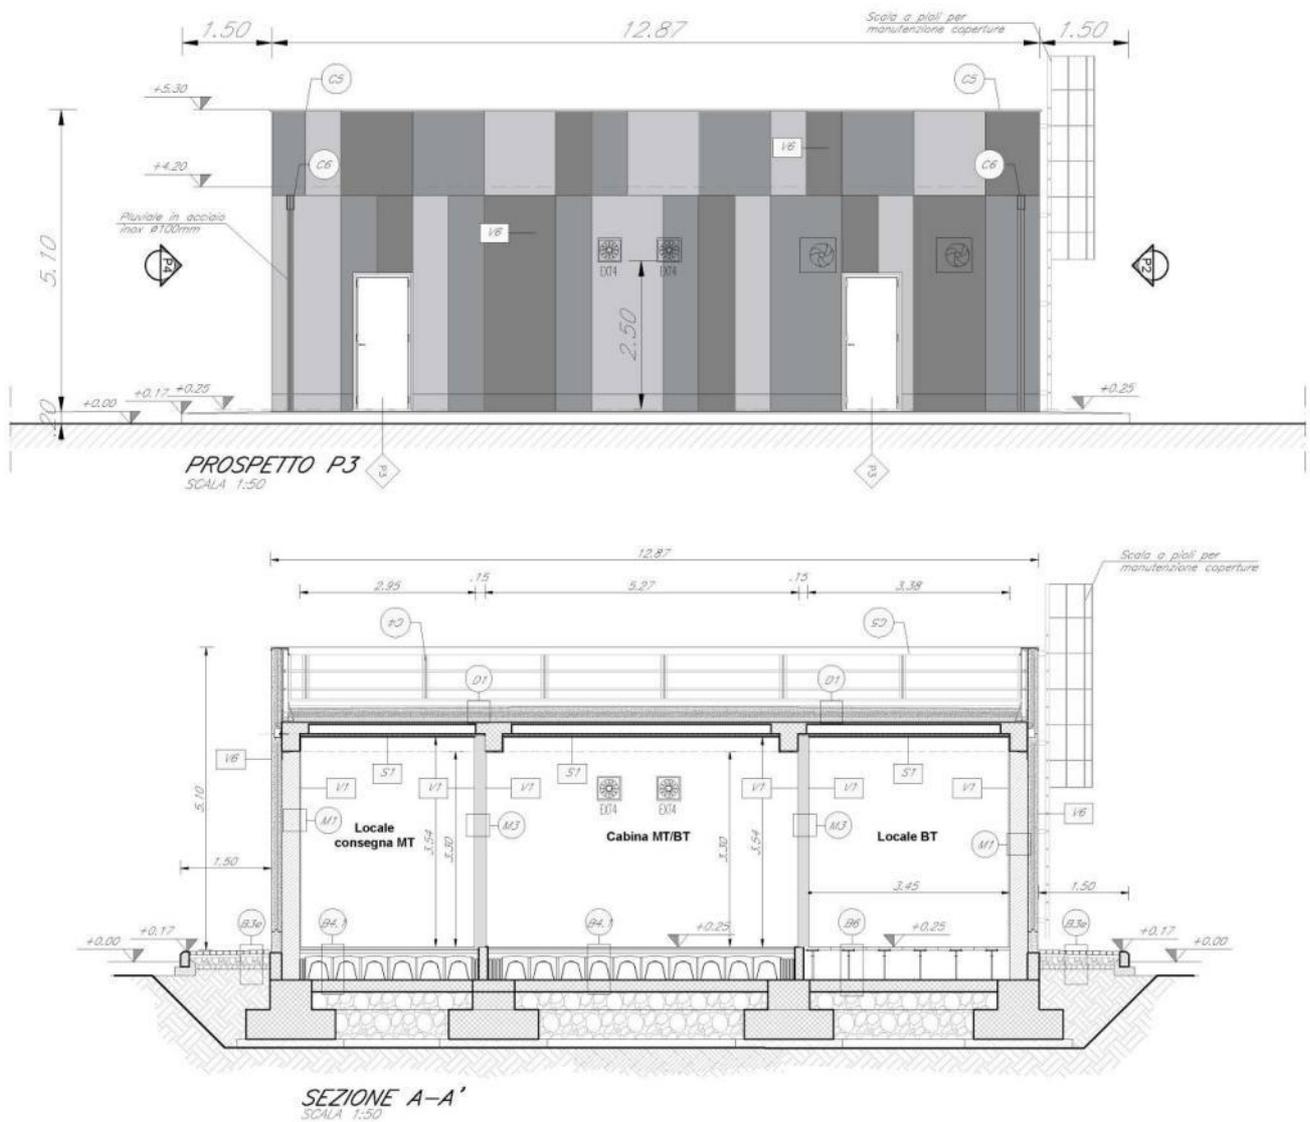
Prospetto e Sezione Fabbricato Energia tipo 3
